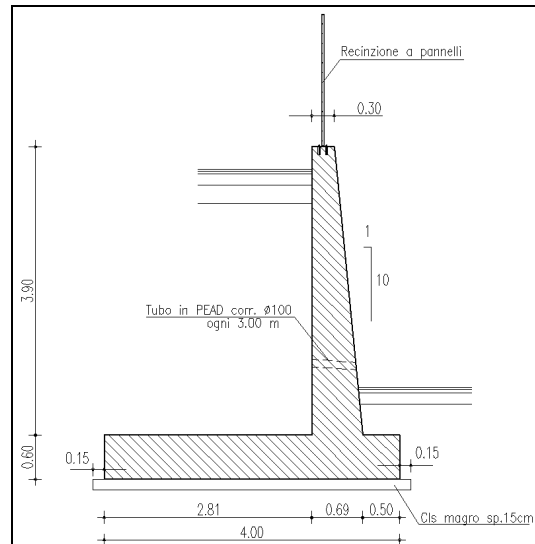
Sezione trasversale muro contenimento H=3.90 m
